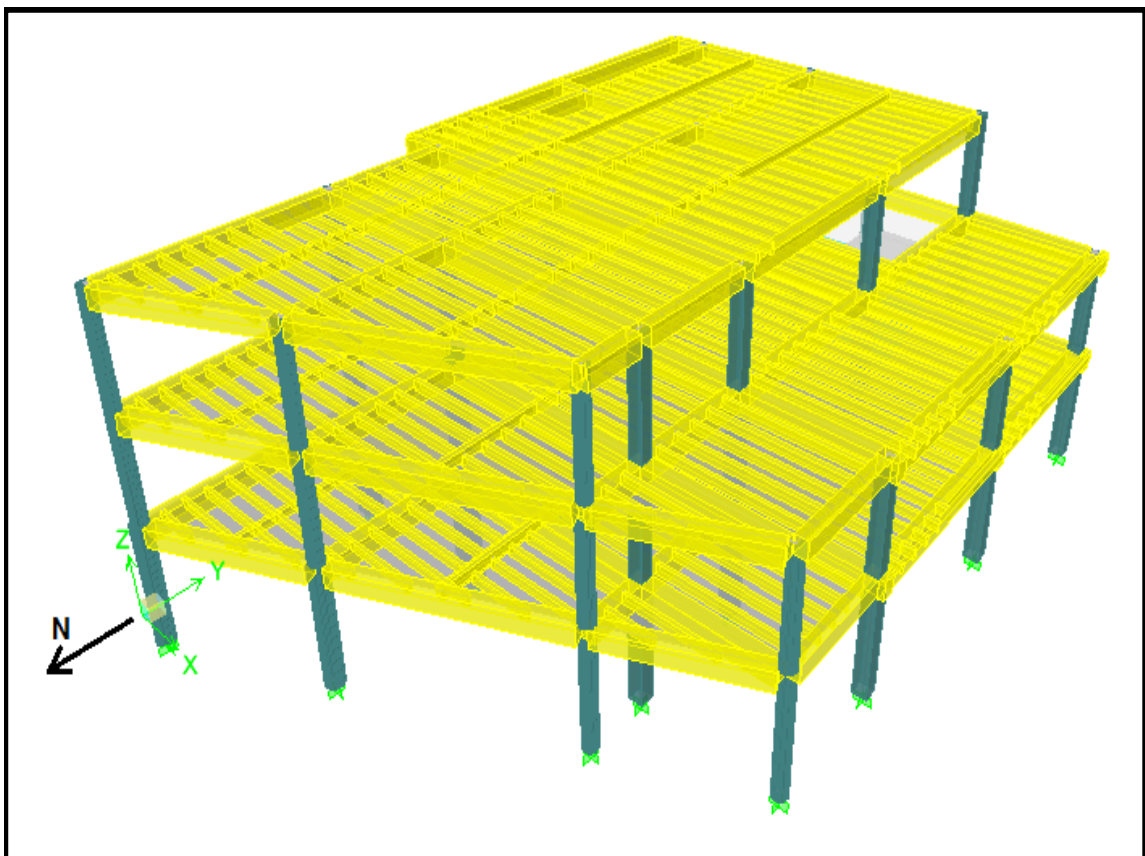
Vista 3D Edificio Módulo2 (Fachada Norte-Lateral Oeste)
